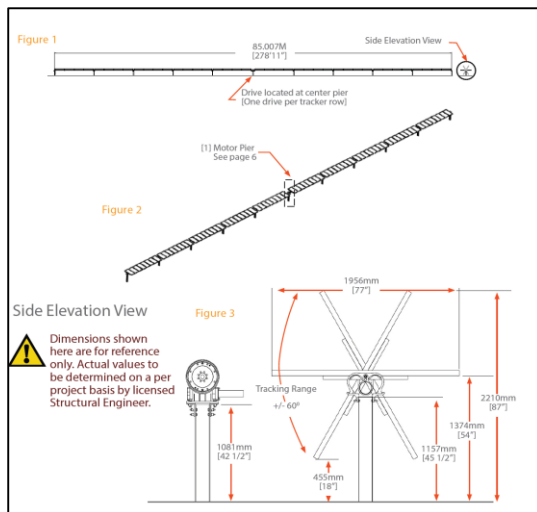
Estructura de soporte y seguimiento de 1 eje horizontal
